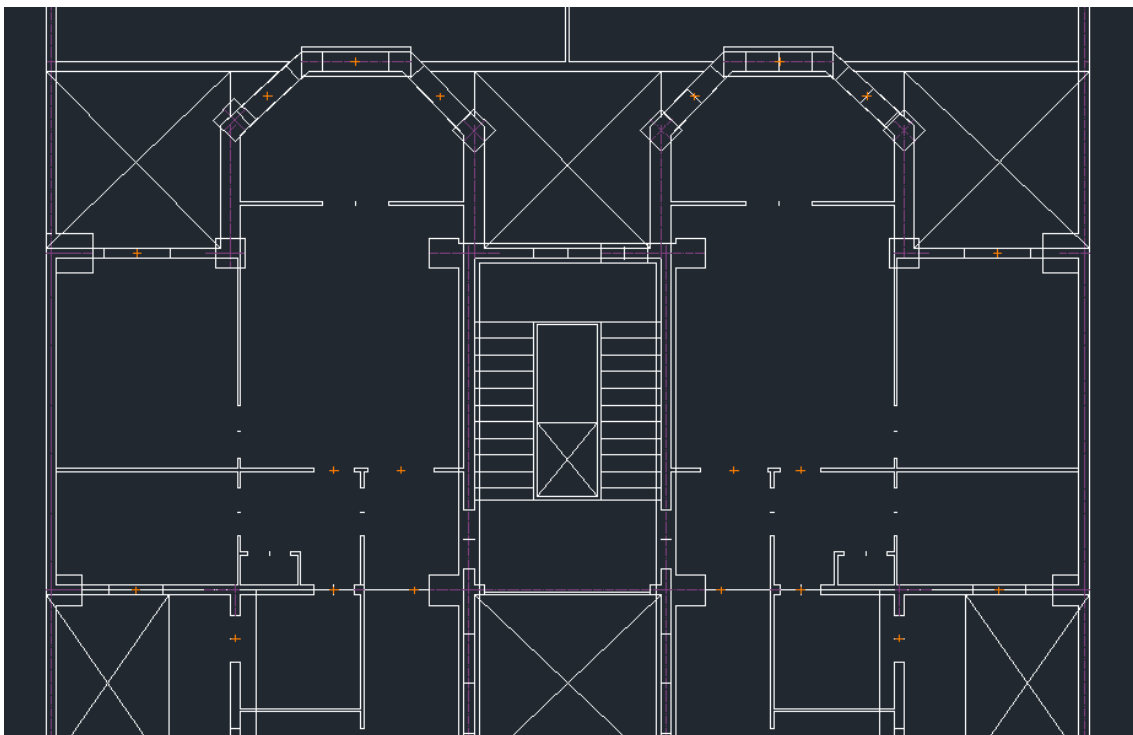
13 Superposición de los muros interiores de la planta baja y de la planta tipo
